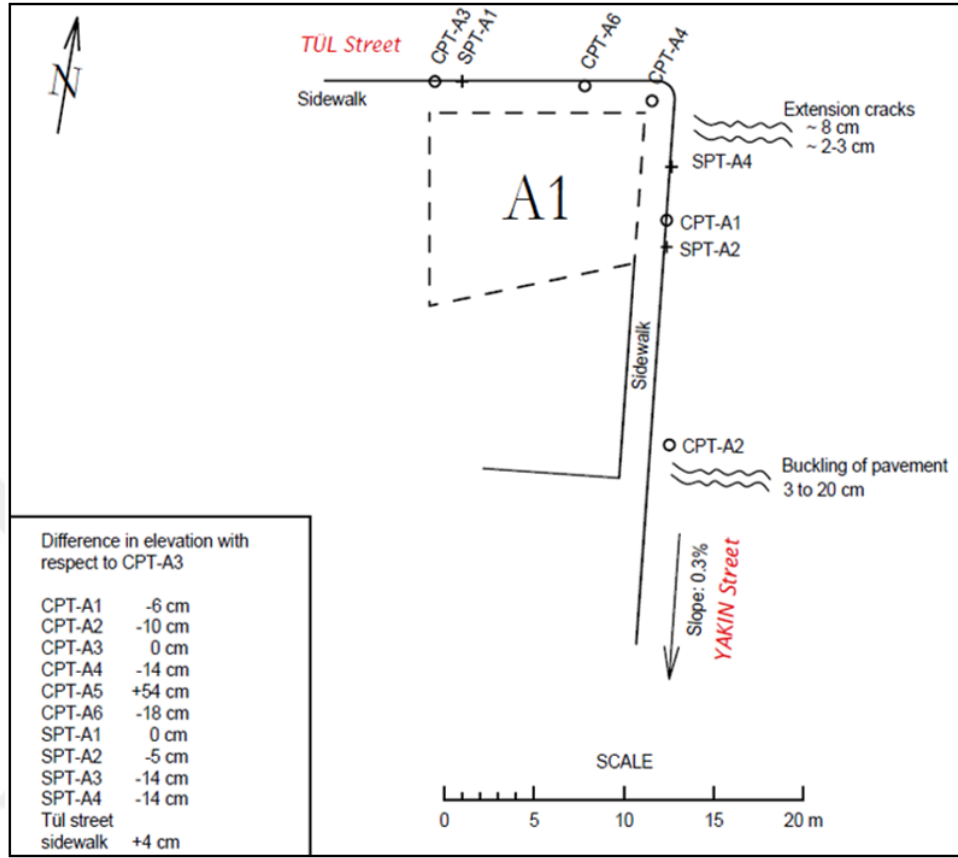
Sapanca Vakıf Otel'i arazi planı (URL-3)
